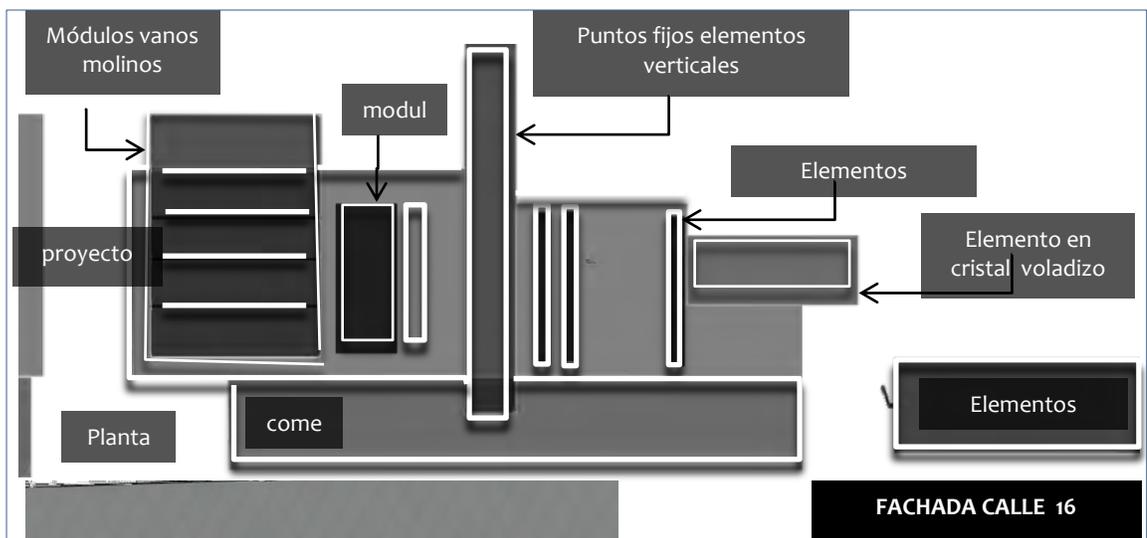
fachada calle 16 análisis fachadas propuesta /7fuente esta investigación//
